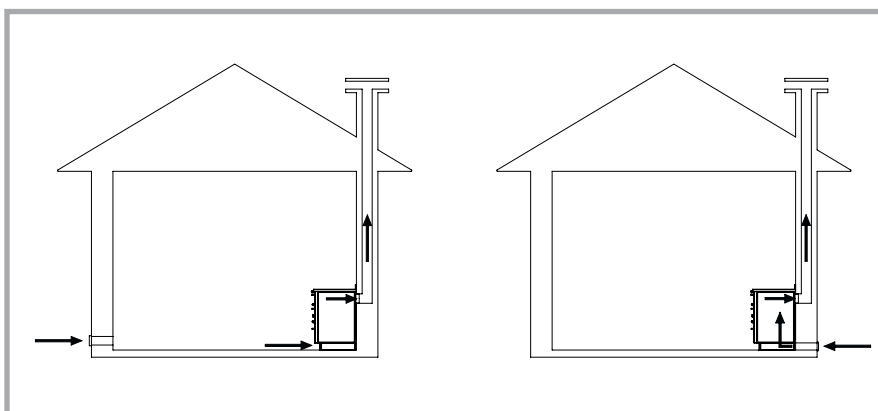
Installazione mediante presa d'aria nel locale e installazione con presa d'aria esterna collegata direttamente alla cucina a legna.
